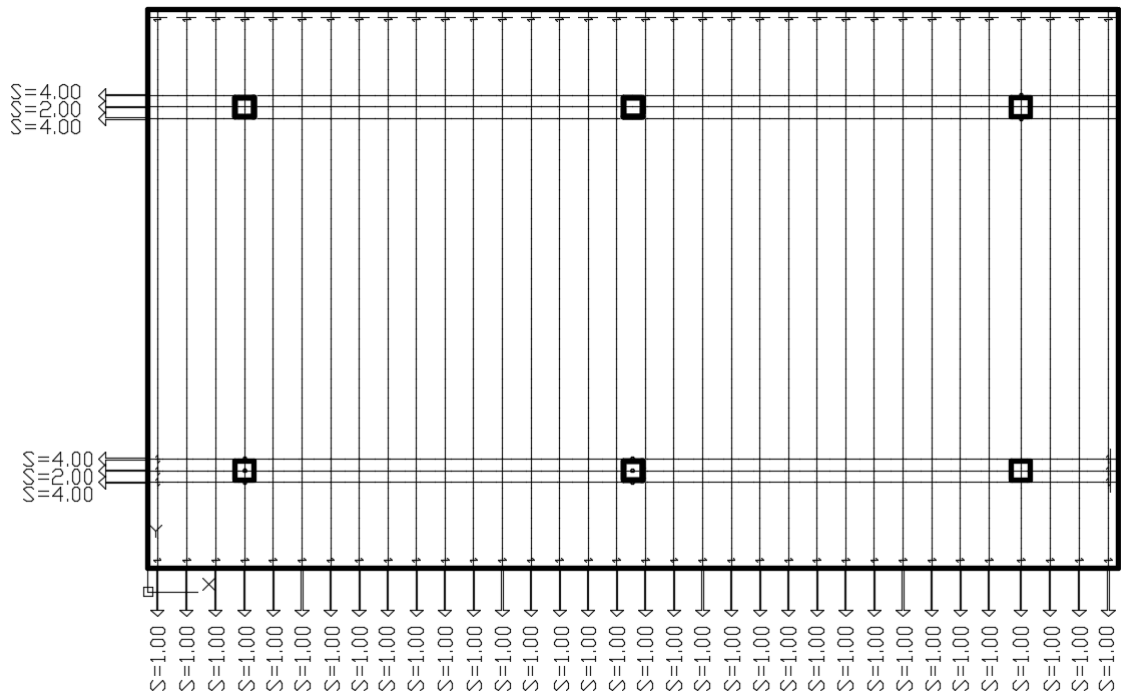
Distribuição dos cabos em planta. (Autor, 2019)
